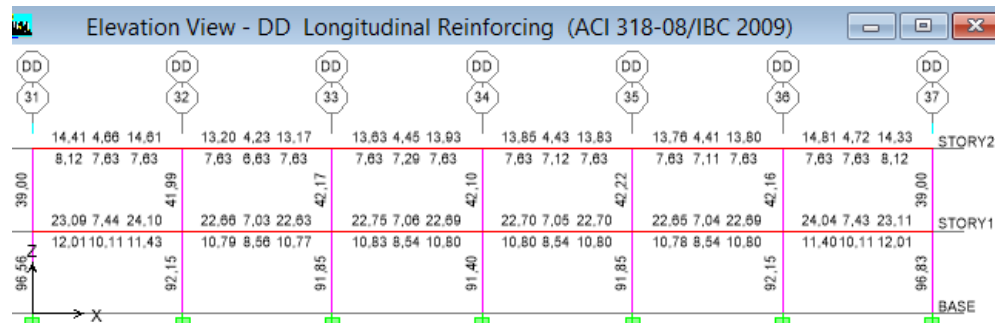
Acero en Vigas y Columnas en el Pórtico DD – Obstetricia - (NEC-11)
